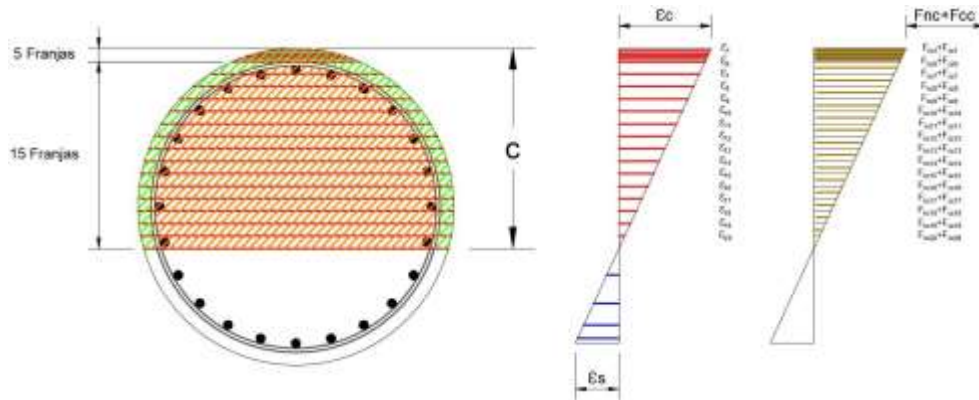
Esquema para el cálculo de fuerzas de concreto no confinado y confinado en la zona de compresión.
